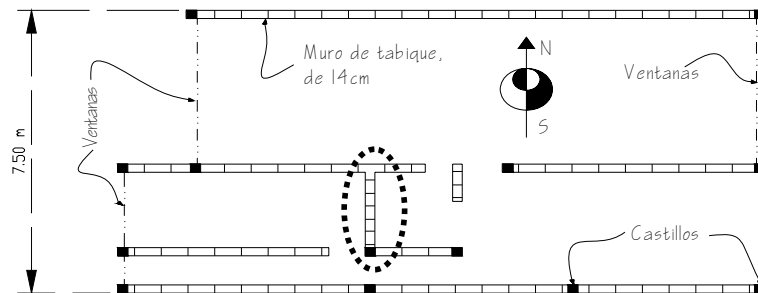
Plano de planta baja de la casa en la cerrada de Romero de Terreros # 52. Solo tenía un muro de 2.5m en el sentido Norte-Sur (Marsal, 1958).
